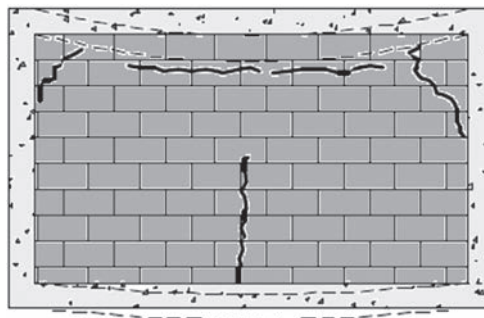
Flecha da viga inferior menor que a da viga superior (adaptada de PEFFERMANN, 1968).
